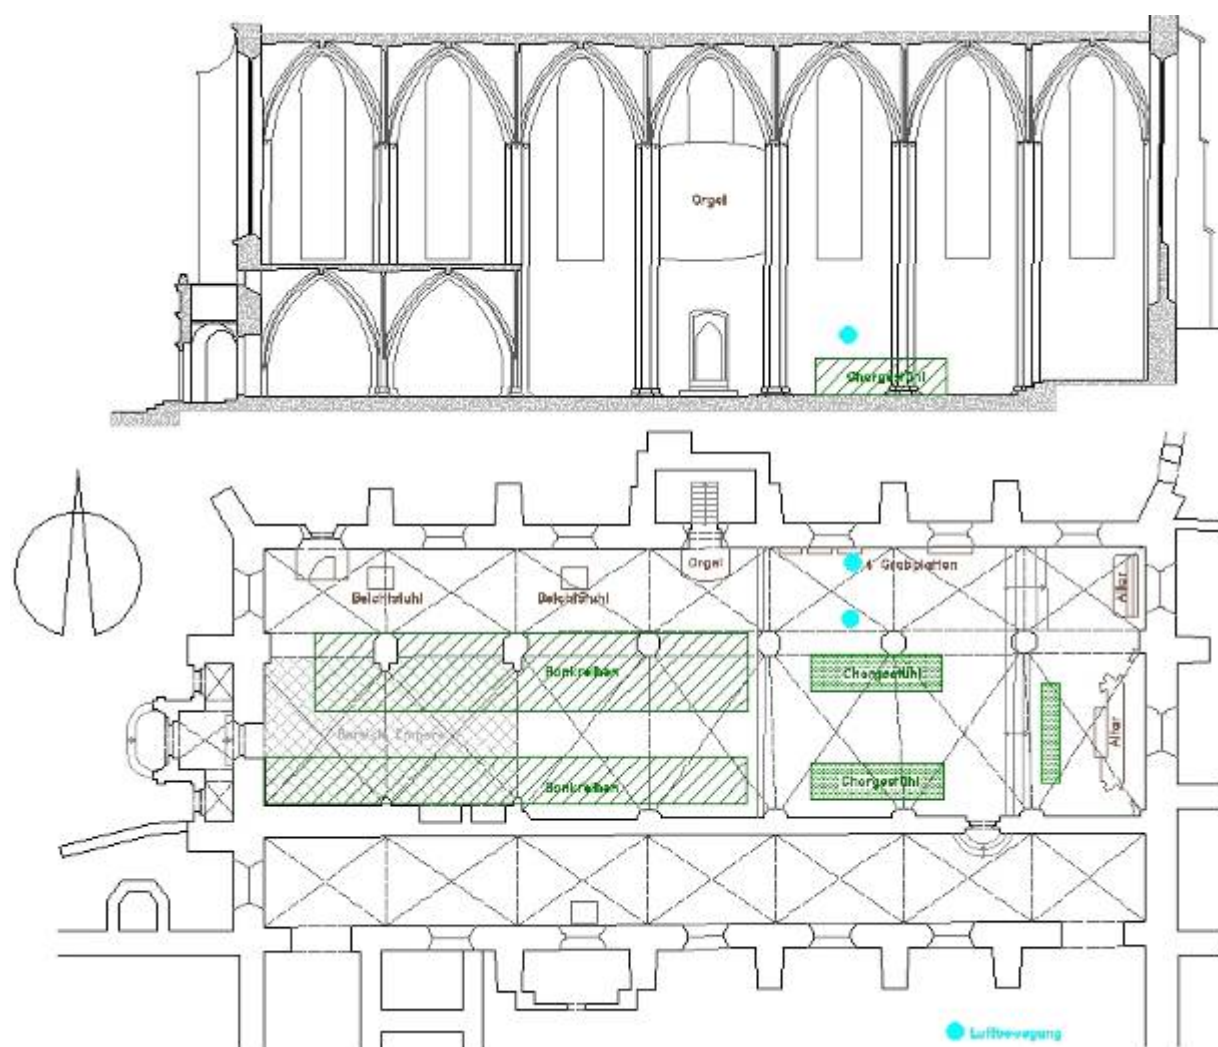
Grundriss und Schnitt der Klosterkirche St. Marienstern mit den Messpunkten Luftströmungsmessung
